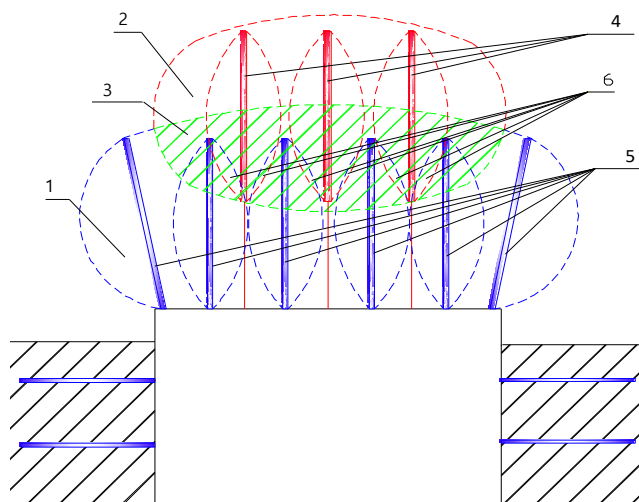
Способ двухуровневого крепления пород кровли горной выработки
